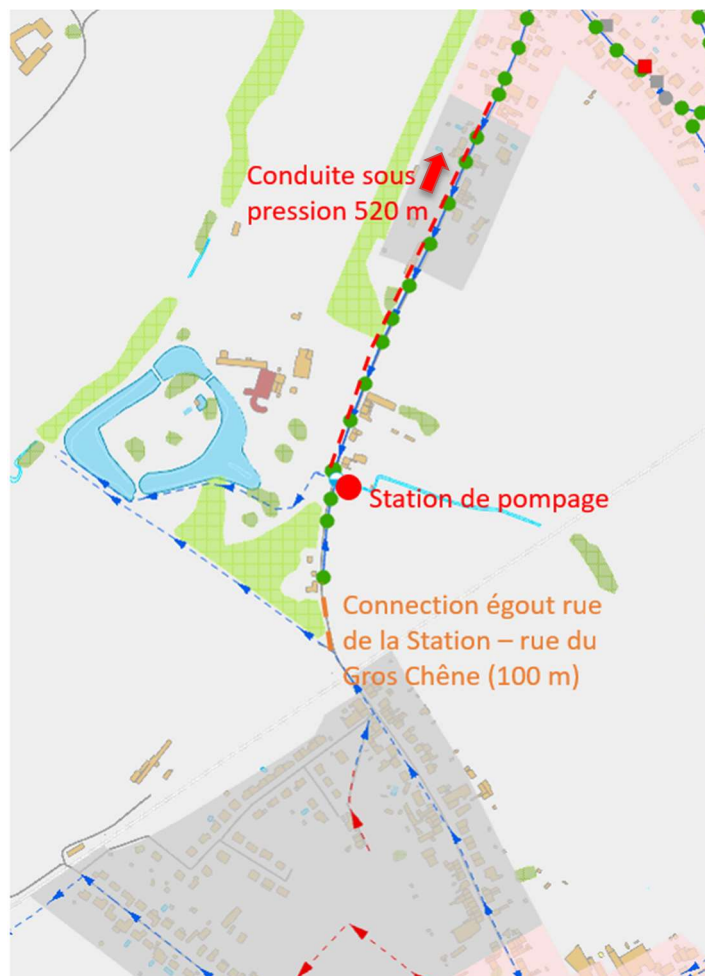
scénario de collecte et refoulement des eaux vers Mussain
